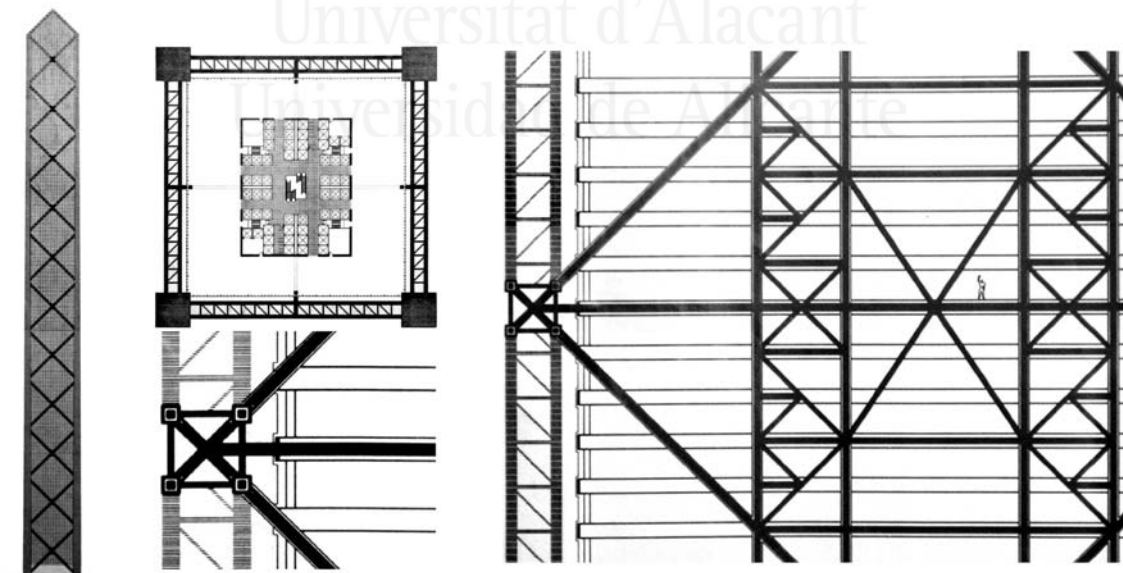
Erawon Center, William J. LeMessurier, 1980. Fachada, planta tipo y detalles de las diagonales de rigidización. Ilustraciones extraídas de "*William J. LeMessurier's super-tall structures: architecture/engineering*" (Rastorfer, 1985B, p.152) y de "*William J. LeMessurier's super-tall structures: A search for the ideal*" (Rastorfer, 1985A, p.144).
